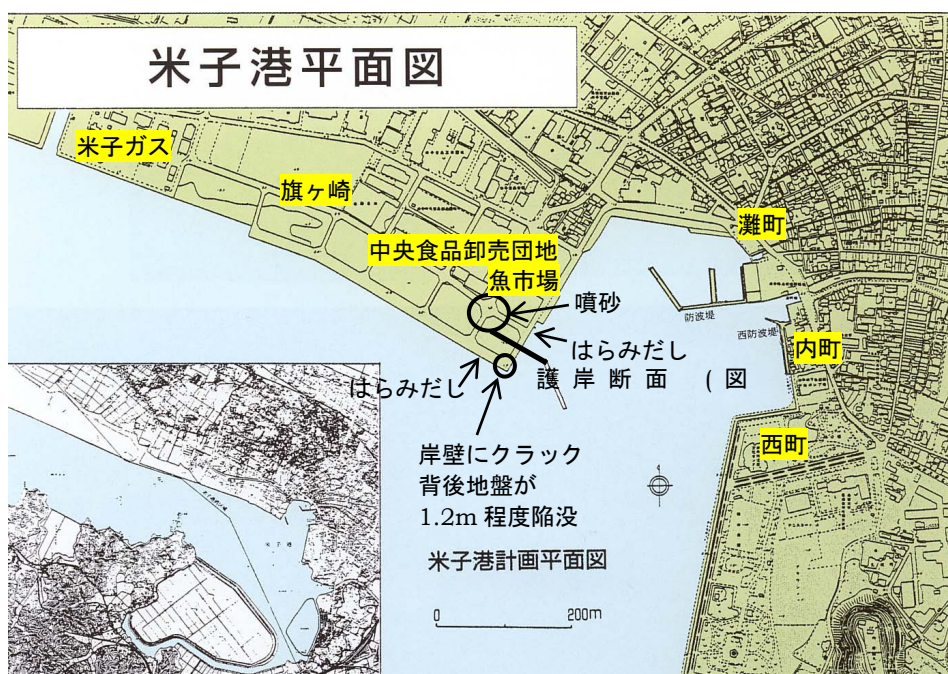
米子港平面図と被害の概要(参考文献3に加筆)
